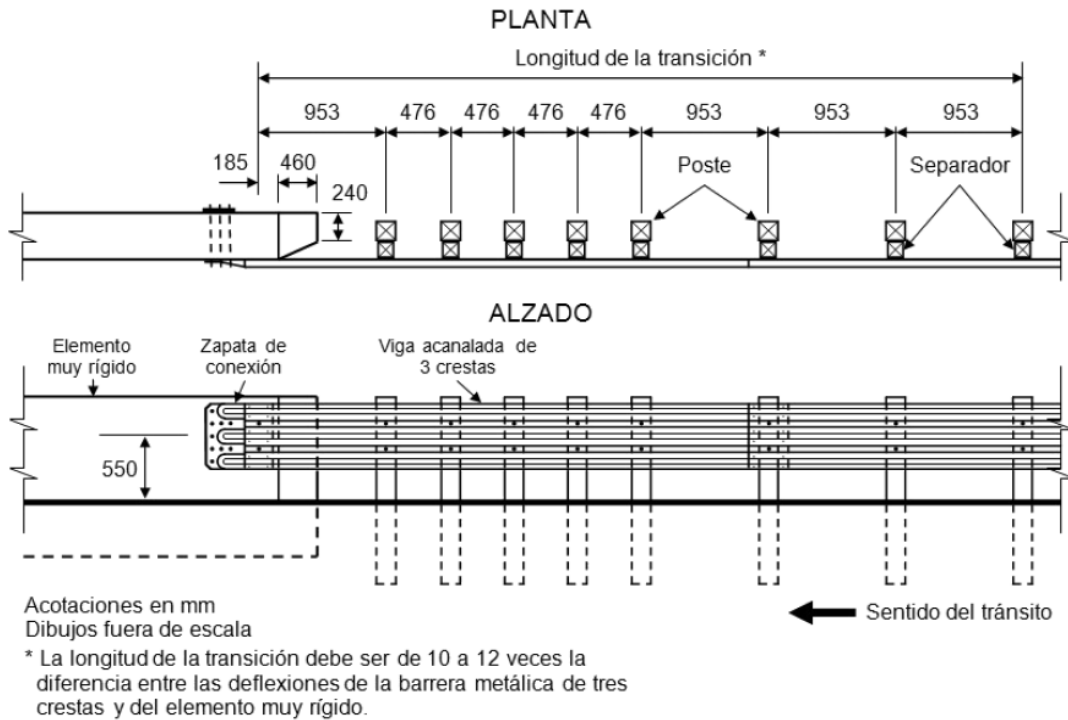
Transición de barrera metálica de tres crestas a muro vertical recto
